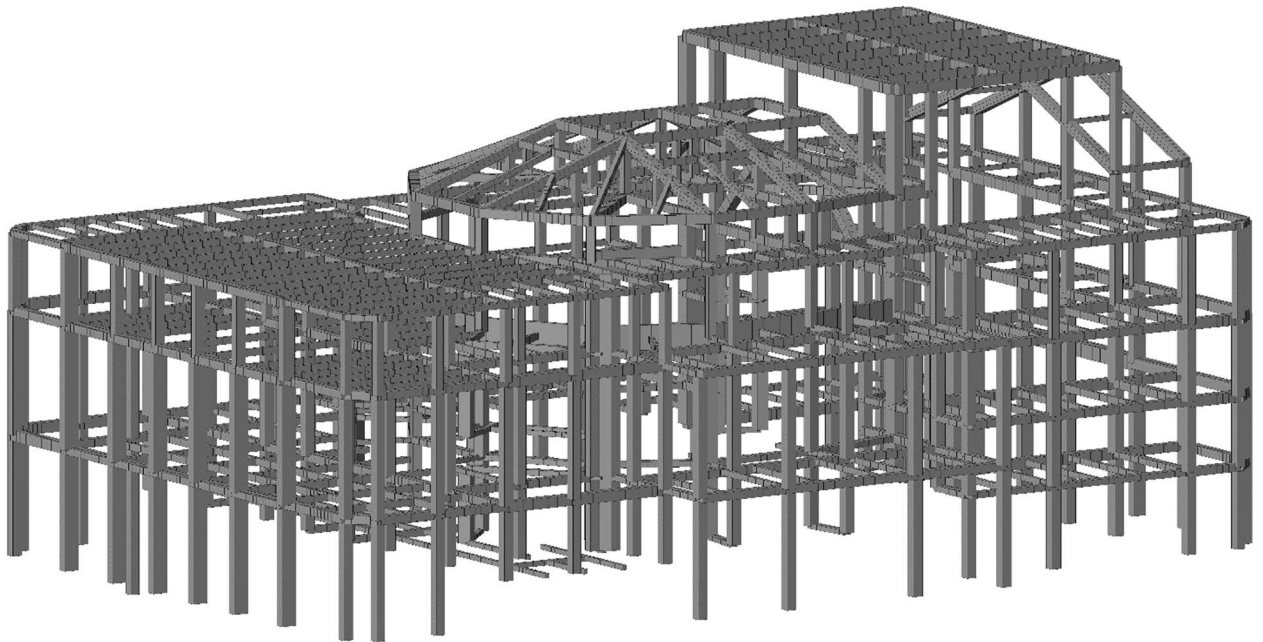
Telaio dopo l'assegnazione delle sezioni agli elementi Beam
